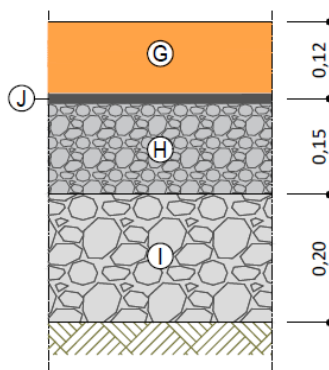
Pormenor do pavimento Tipo III – Acessos; Paragem BUS; Kiss and Ride; Táxis
